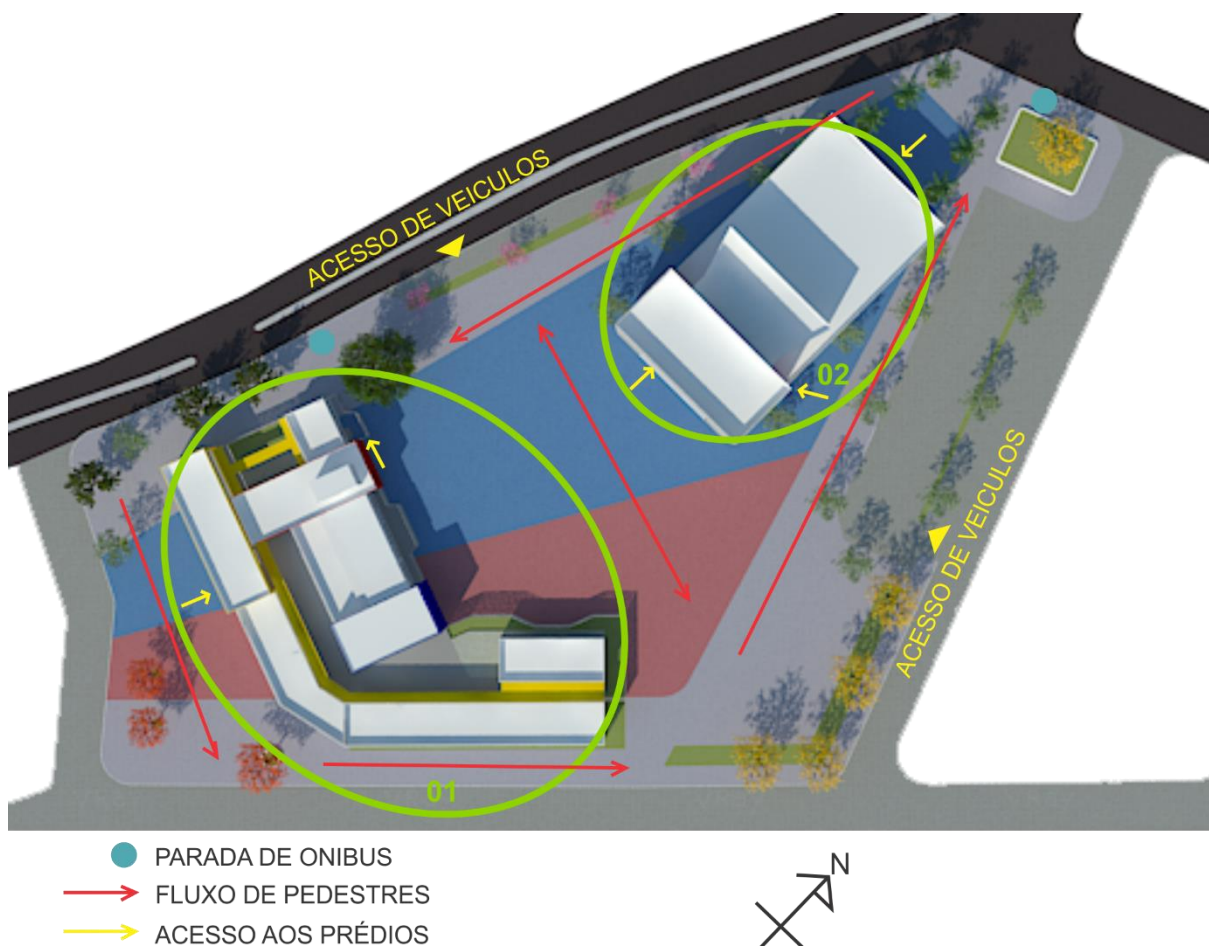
Planta de Implantação da Escola de Artes Técnicas
